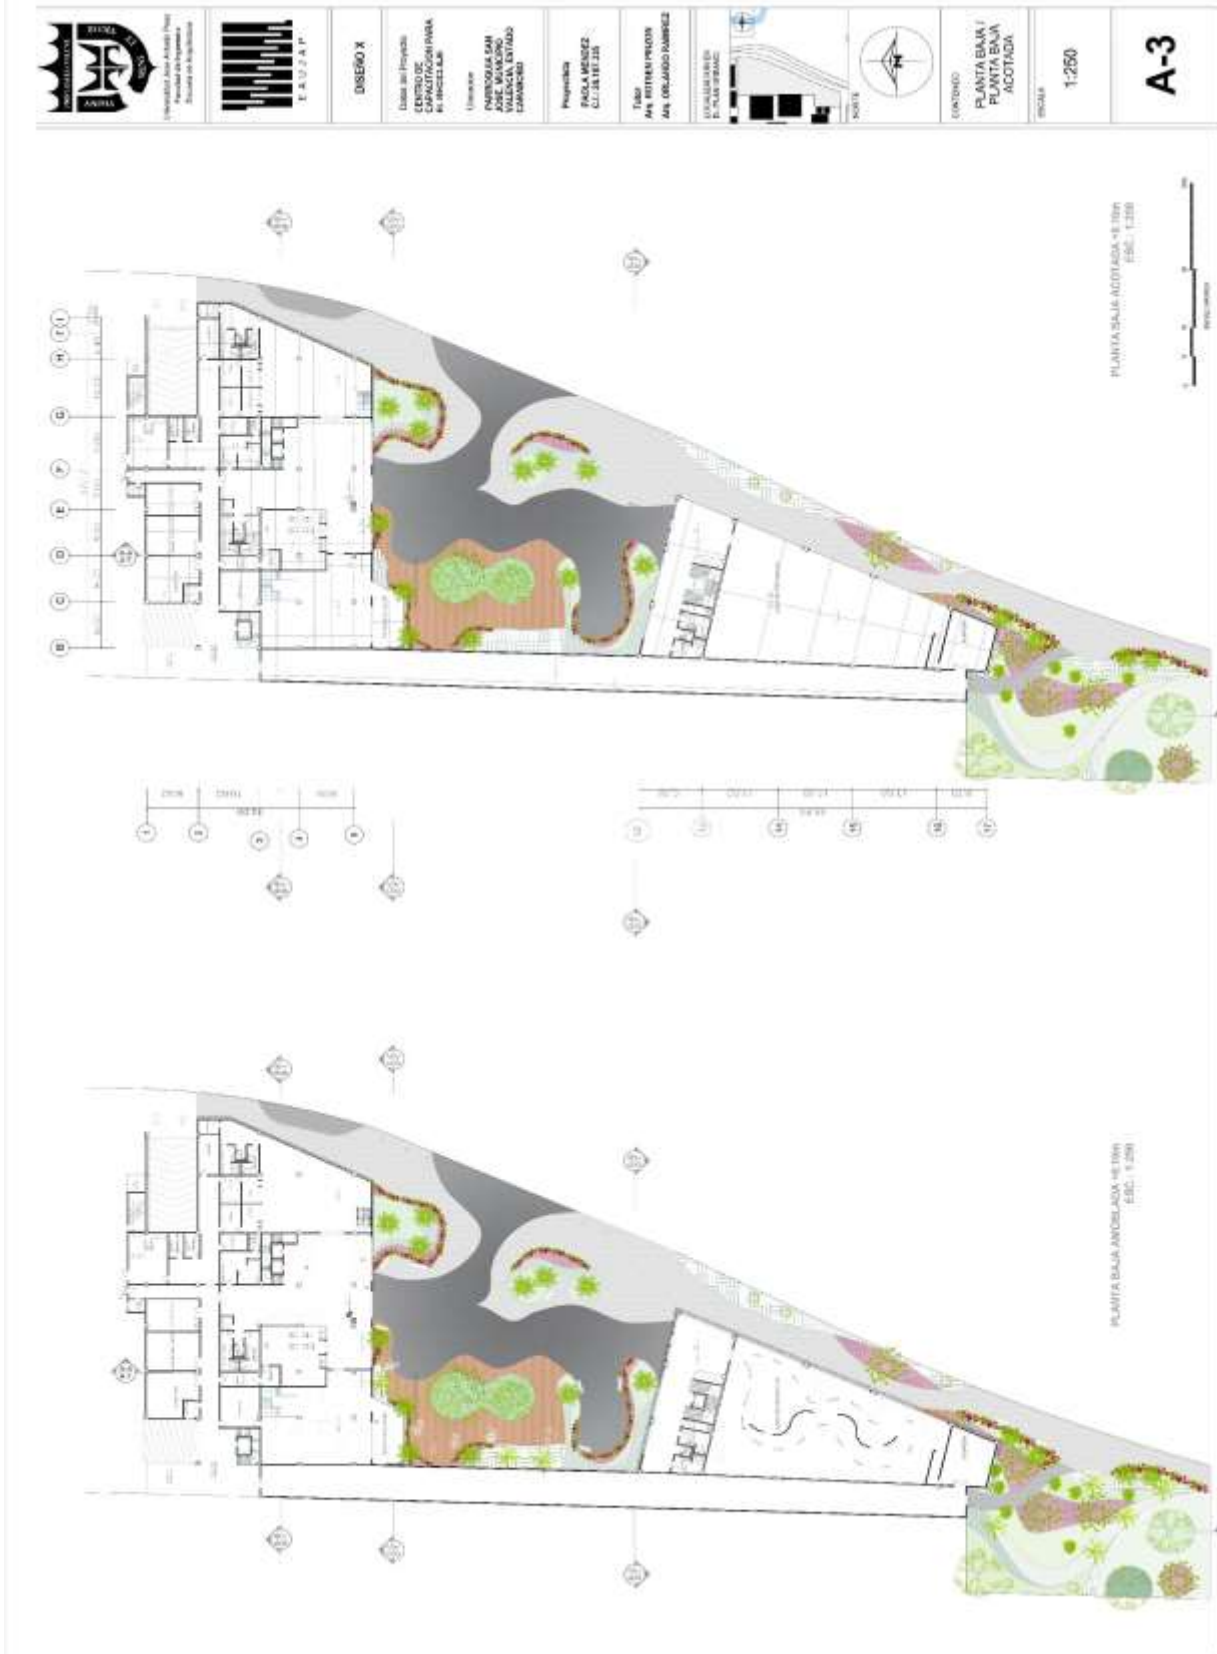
A-3 Plantas Fuente: La Autora (2023)
